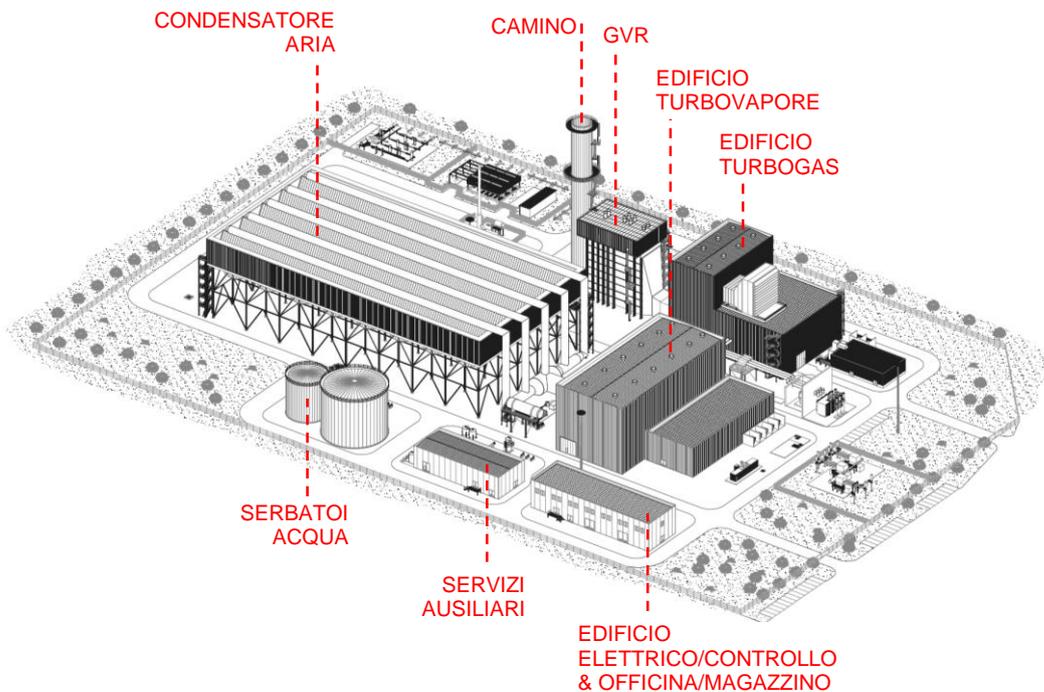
(1 di 2) Vista assometrica da Sud-Est – Stato attuale autorizzato
